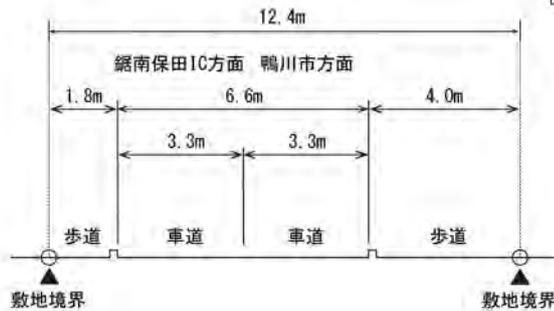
(4) 予測断面図 (D 県道 34 号鴨川保田線)
